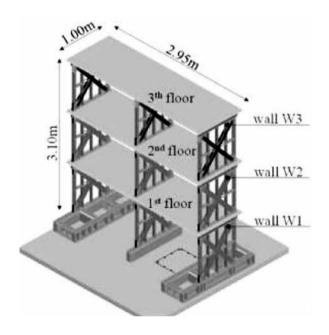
Полномасштабные испытания экспериментального образца LAMIEREDIL [32] Fig. 6. A full-scale testing of the LAMIEREDIL sample [32]
